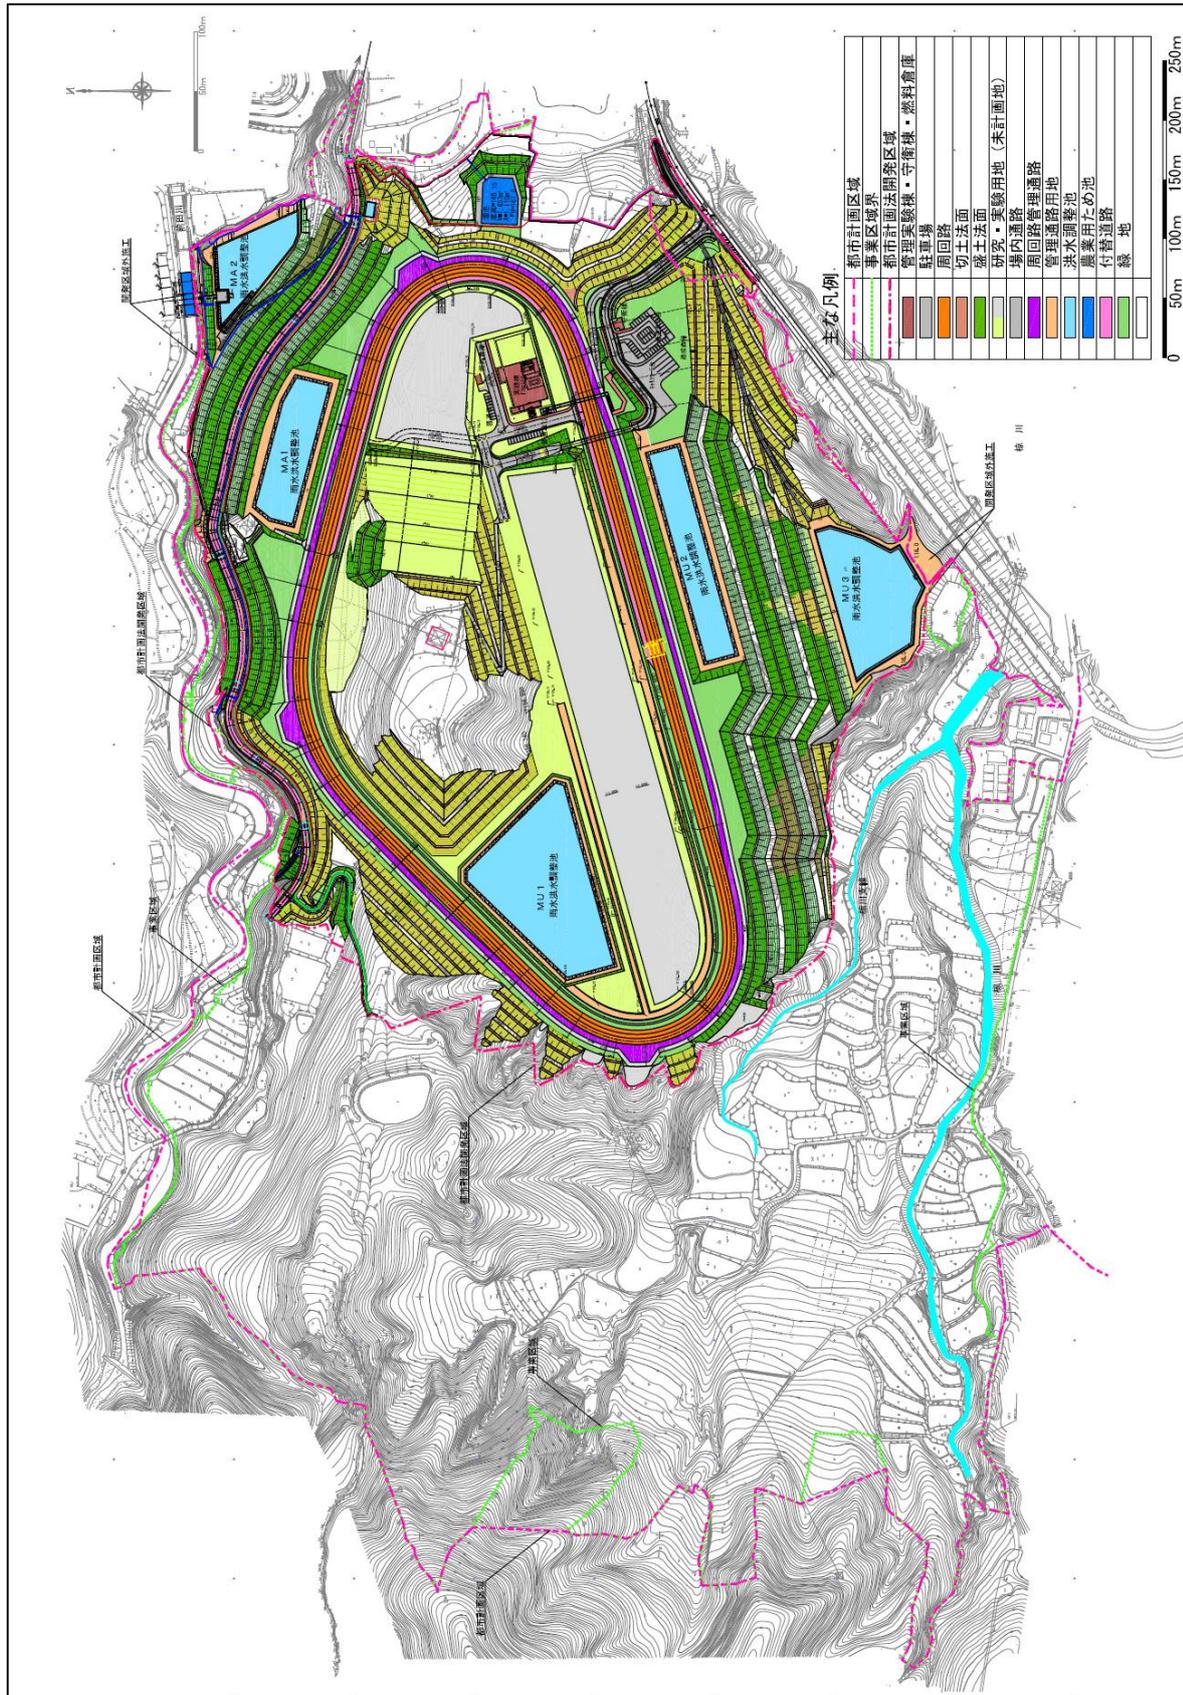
土地利用計画平面図 (第 1 回変更)
